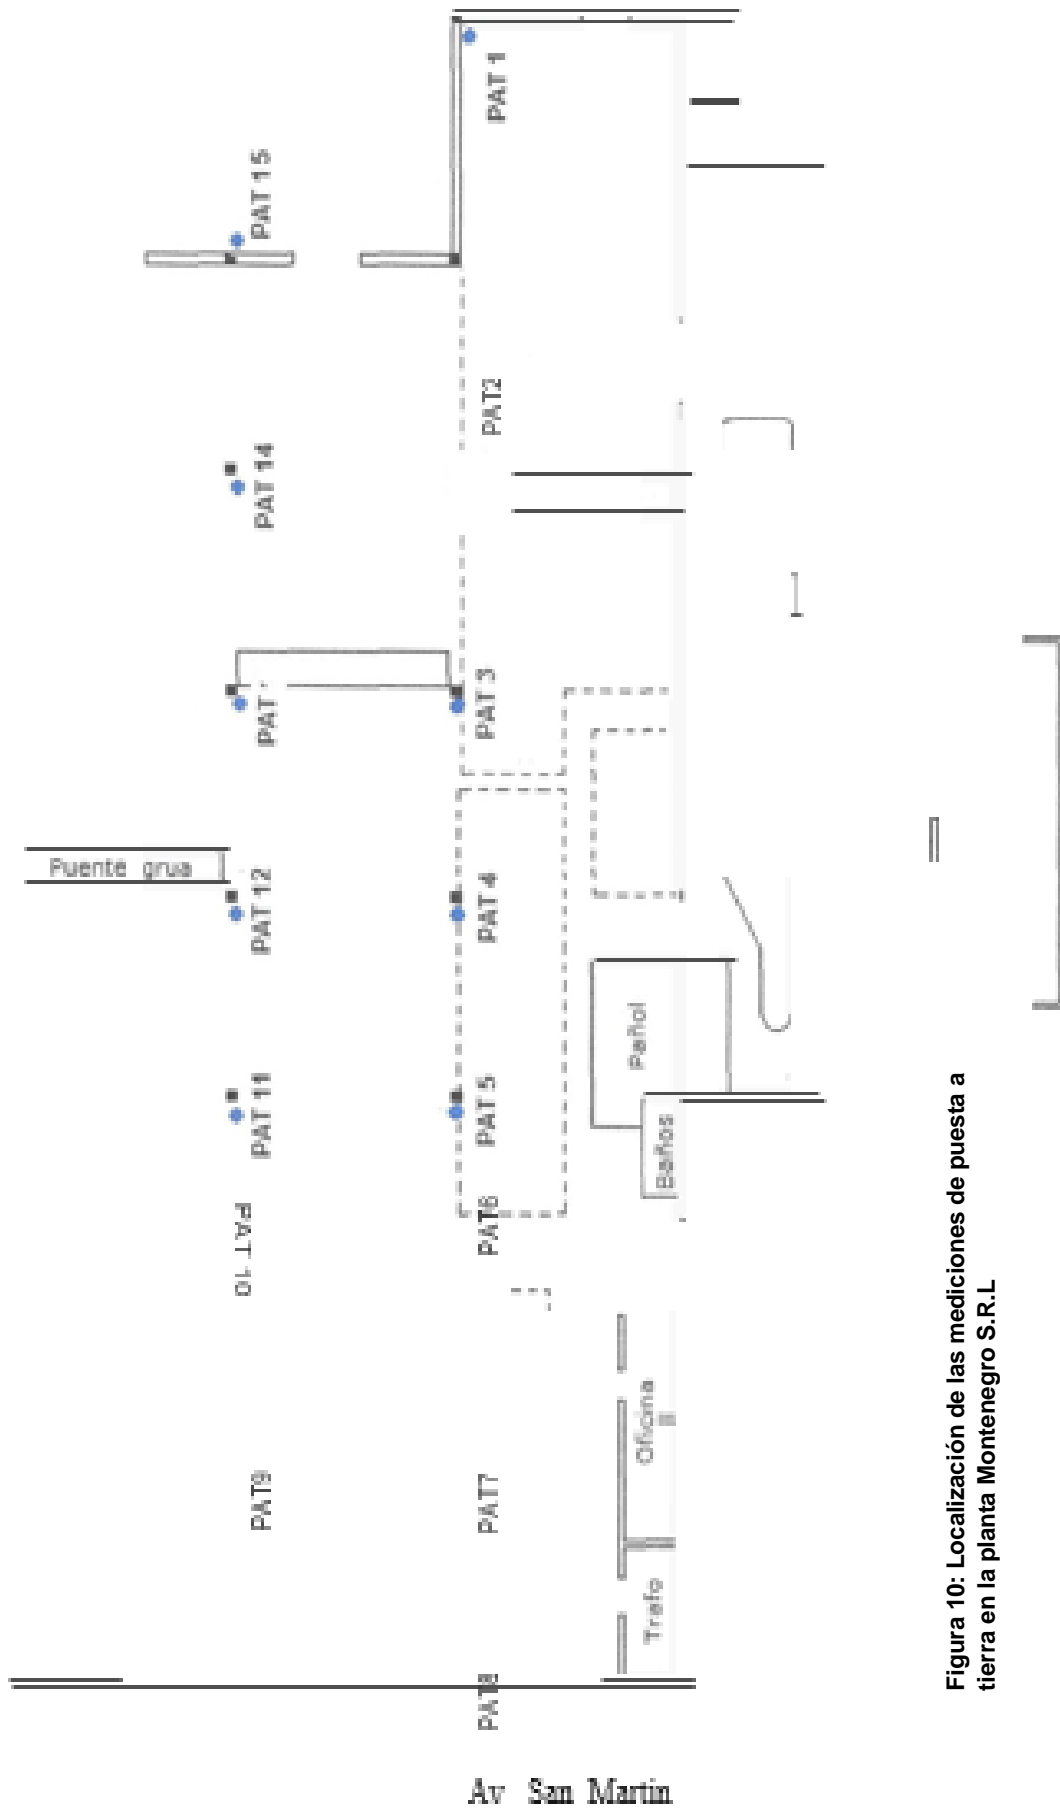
Localización de las mediciones de puesta a tierra en la planta Montenegro S.R.L
